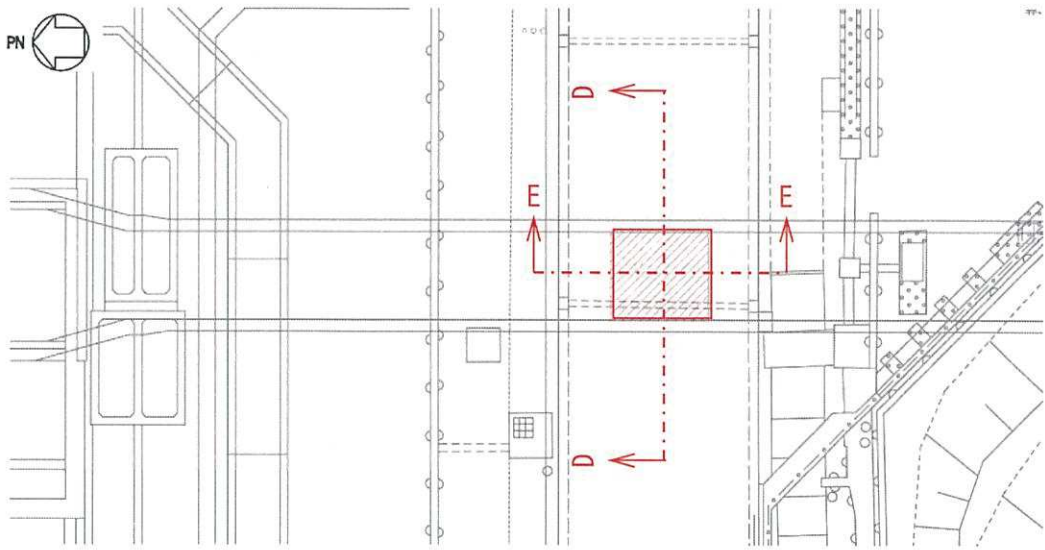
取放水路流路縮小工（第1号機放水路）の平面配置図
